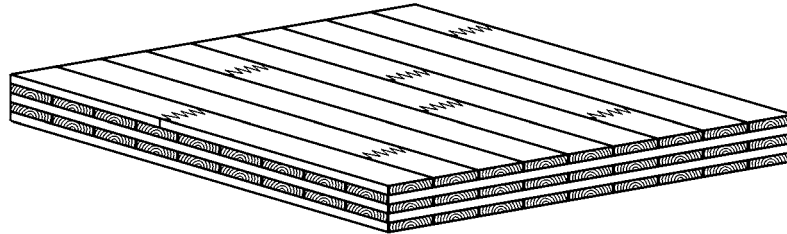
Exemple de dalle lamellée croisée avec lamelles superposées
